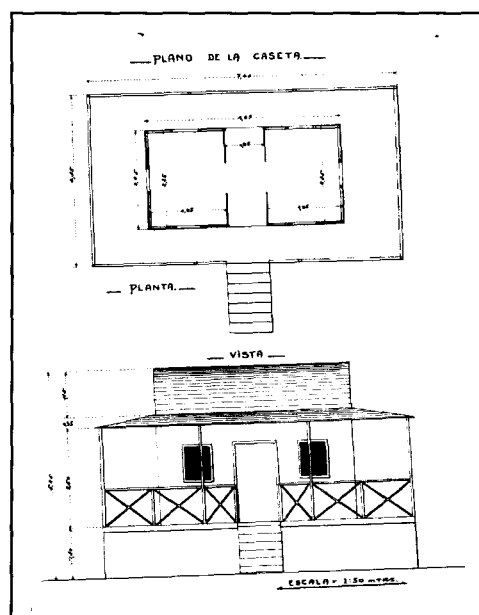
Planta y alzado de la caseta de baño solicitada por la Grand Canary Coaling Co. (1913).
